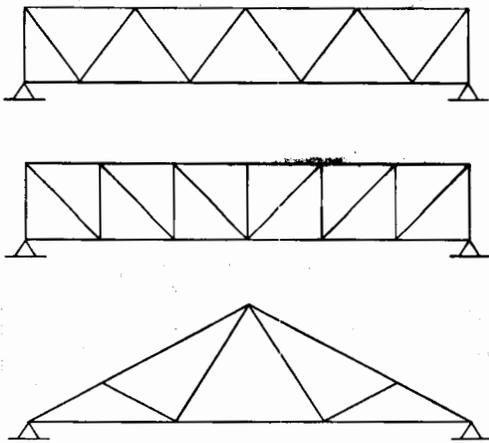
Armaduras para puentes y edificios urbanos o industriales.
